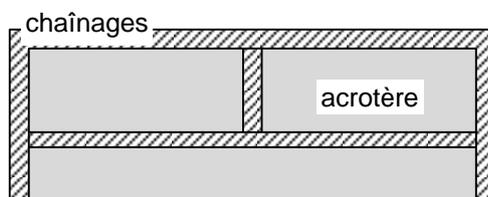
exemple d'encadrement des éléments en console vertical
